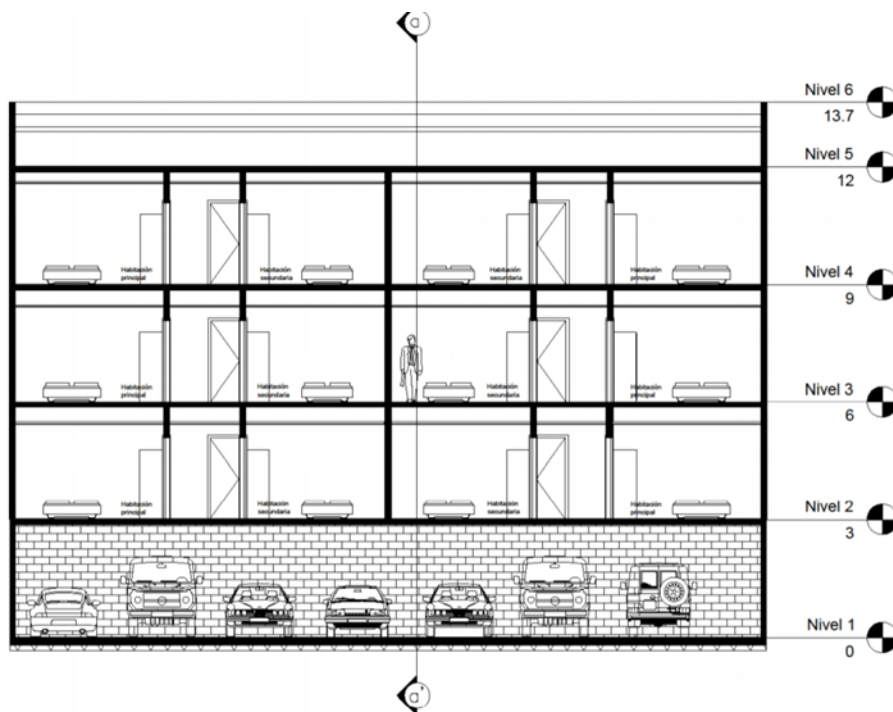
Corte longitudinal de la edificación, constructora Proyectos y Soluciones de Ingeniería P.S.I. Ltda. Fuente: Creación propia.
